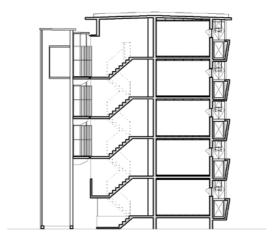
改修後の断面図 / Building Section Showing Added Elevator Tower
